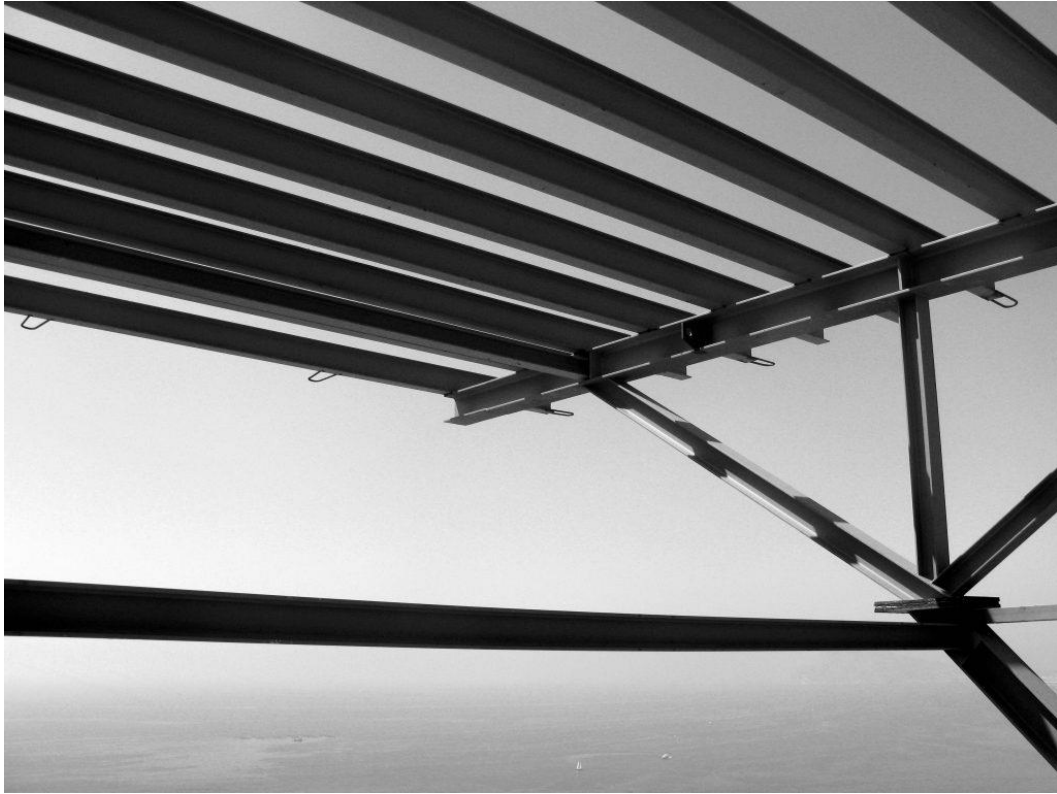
Fotografía fase de ejecución: Perfiles cimbra. Fuente: Estructuras Singulares.
